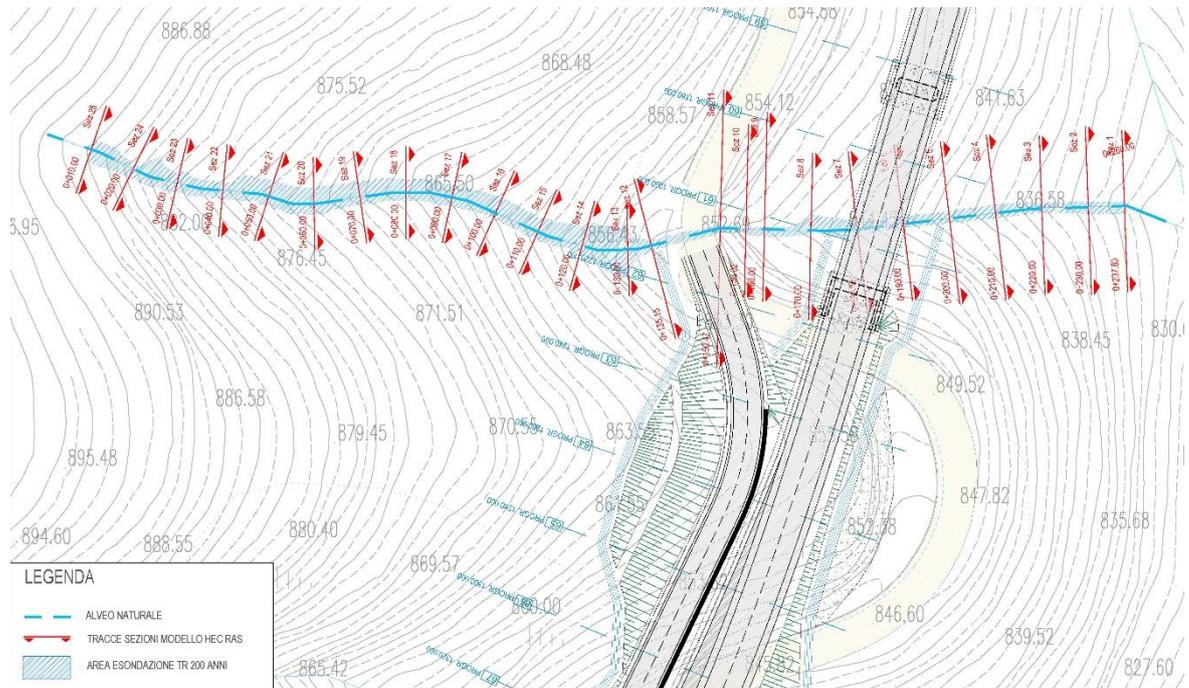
Fiume 20454 – Planimetria aree di esondazione.
